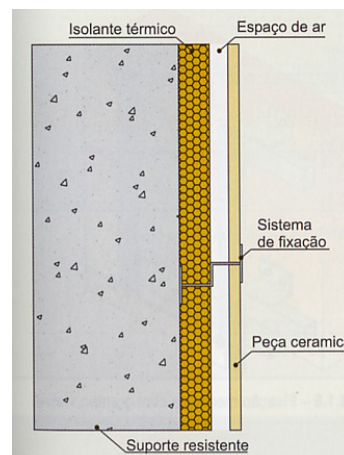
Fachada Ventilada. Pormenor de construção.
